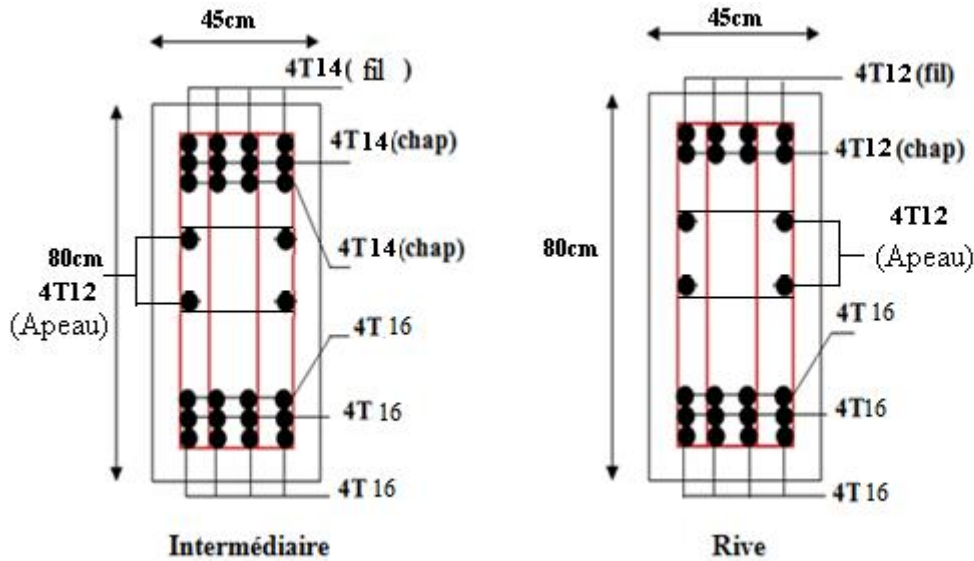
Ferrailage de la poutre de libage suivant le sens longitudinal.
